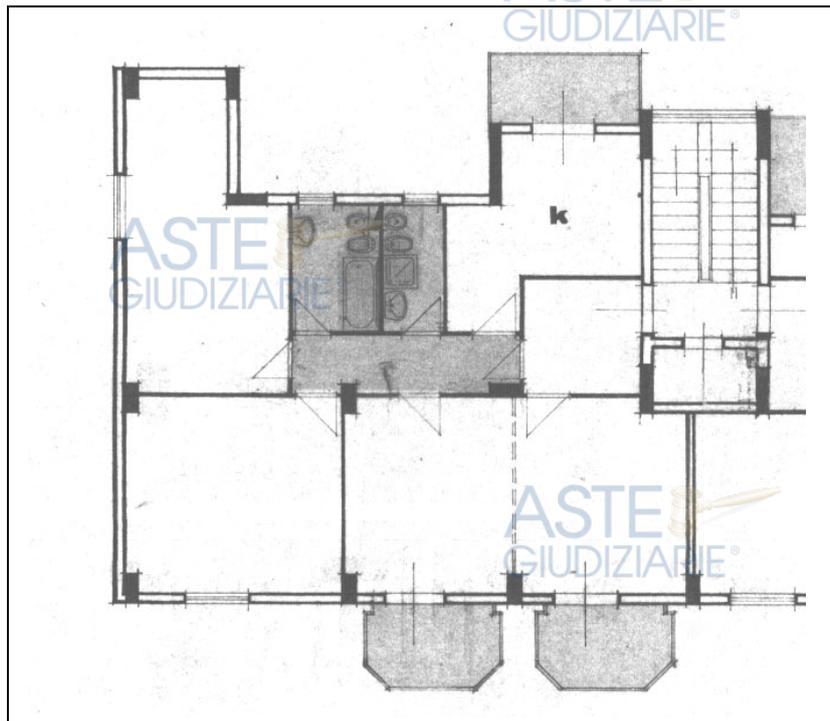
Estratto planimetria di progetto allegata alla concessione edilizia in variante del 1979
